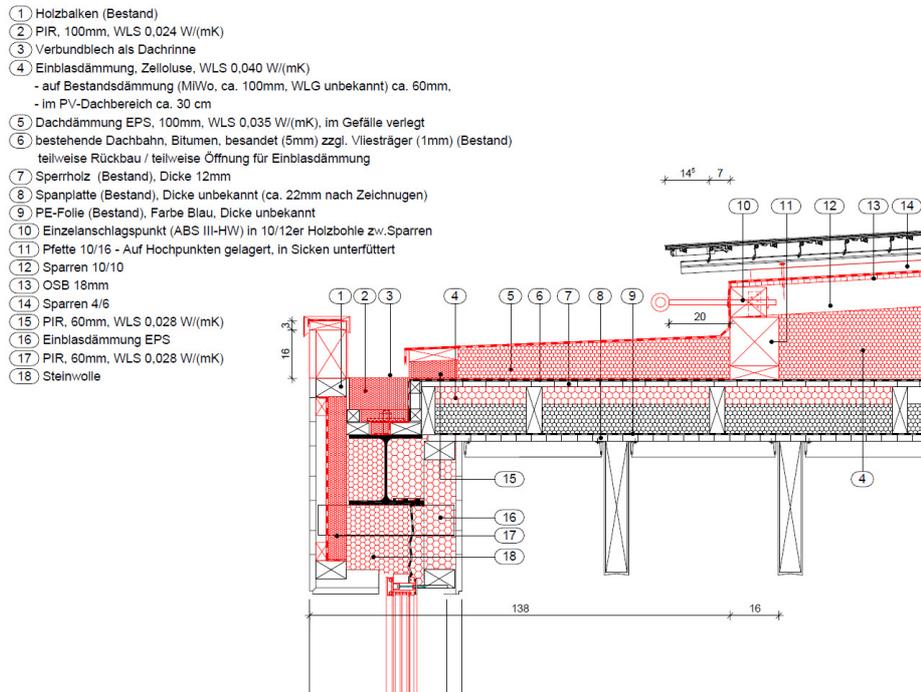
Detail: Sanierung Dach- und Fassadendämmung
